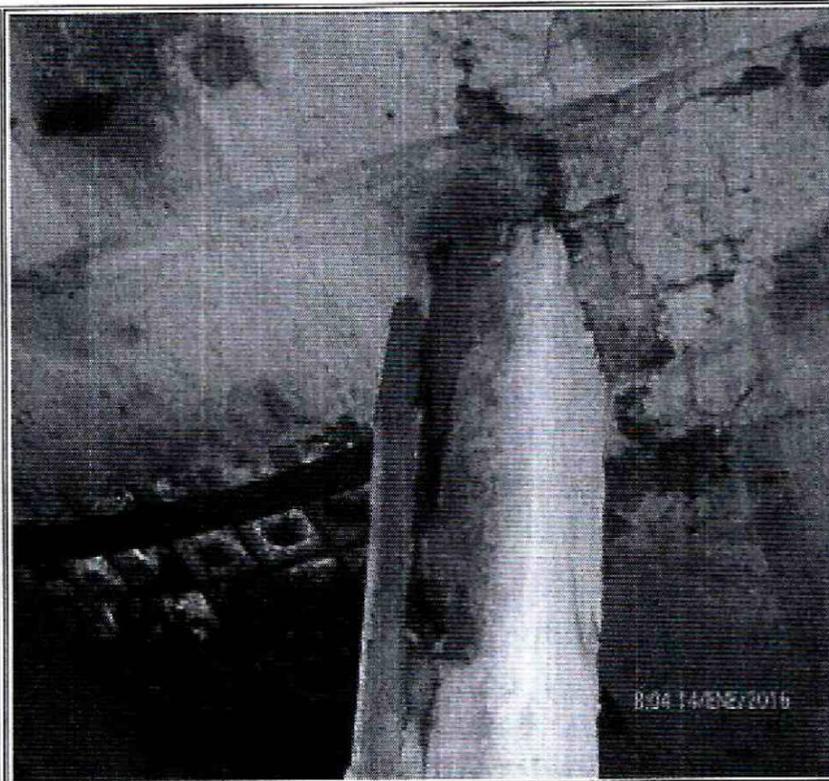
Desprendimiento concreto de columnas del predio de la Carrera 98 B No. 132 C – 13 Urbanización La Chucua
